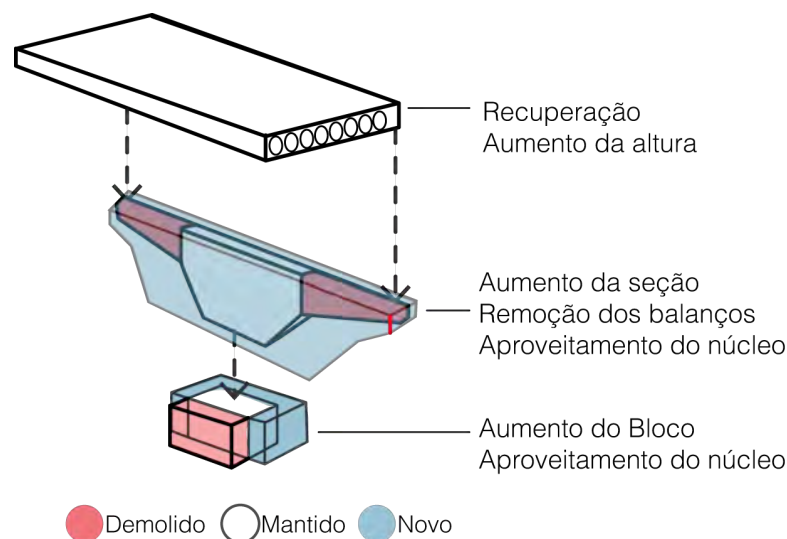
Esquema de Retrofit estrutural do novo pilar em formato “asa delta”, Viaduto sobre a Galeria dos Estados, Brasília, DF (Fonte: autora)
